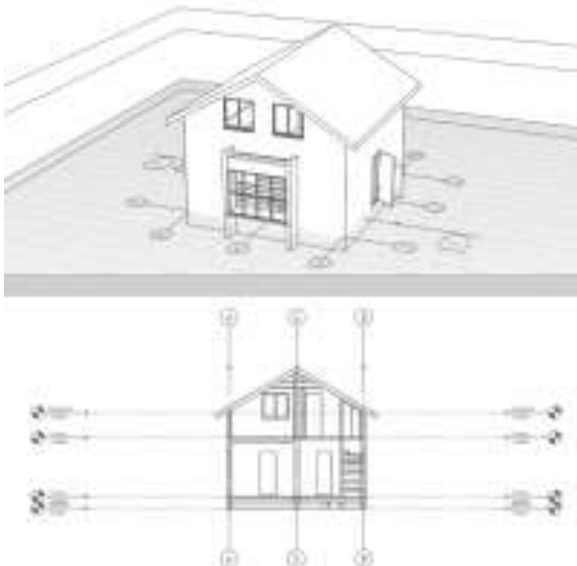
Формирование разреза, фасада здания по 3D модели
